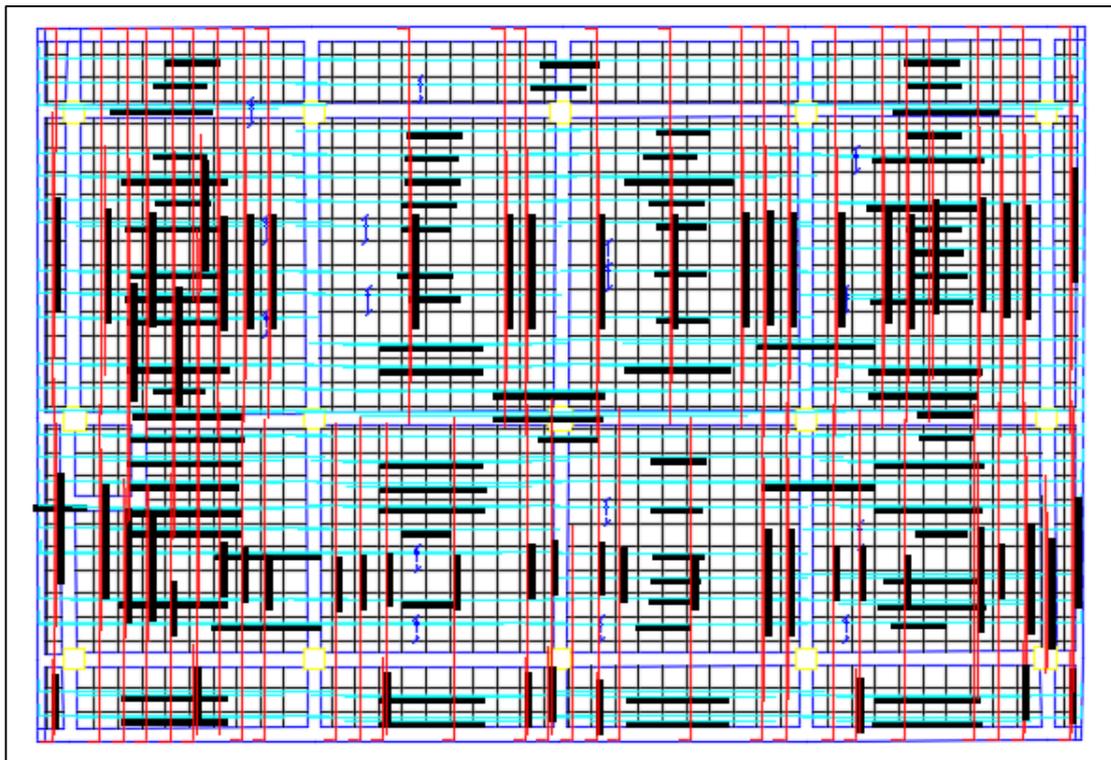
Esquema de armado de losa tipo N+1,62 (Hormigón)
